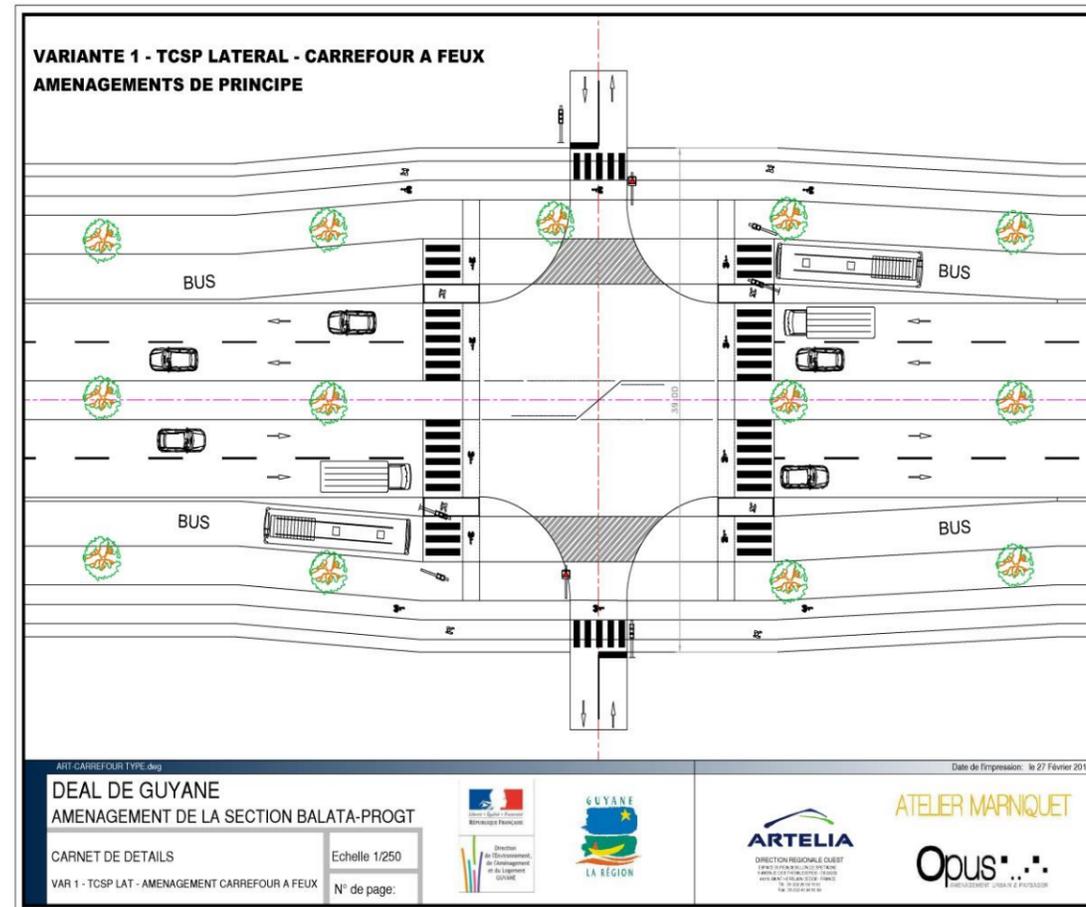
PLAN TYPE DE CARREFOUR A FEUX
